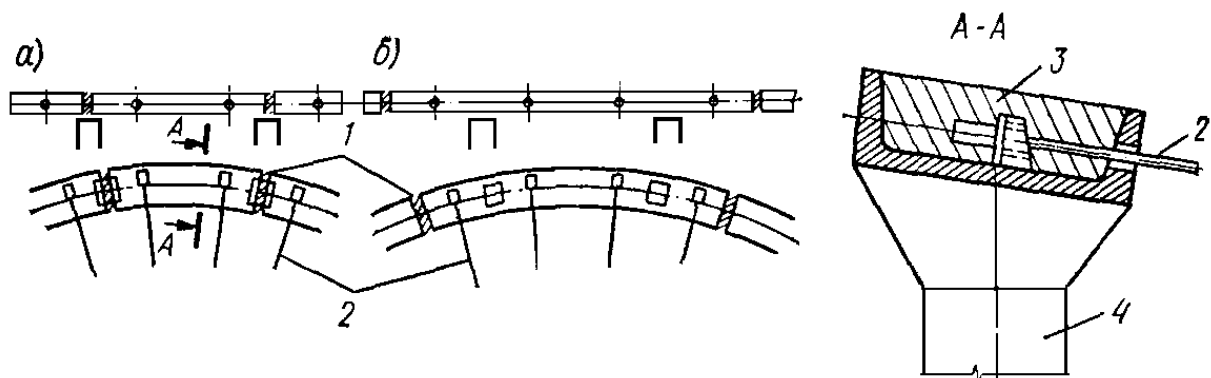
Наружные железобетонные сборно-монолитные кольца висячих однопоясных оболочек
